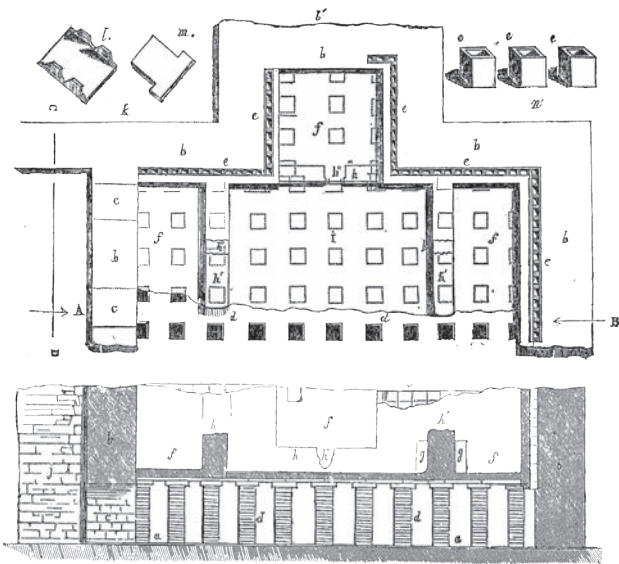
plan et coupe des thermes de Senon dressés par G. Vielliard (1852, p. 370-371)
